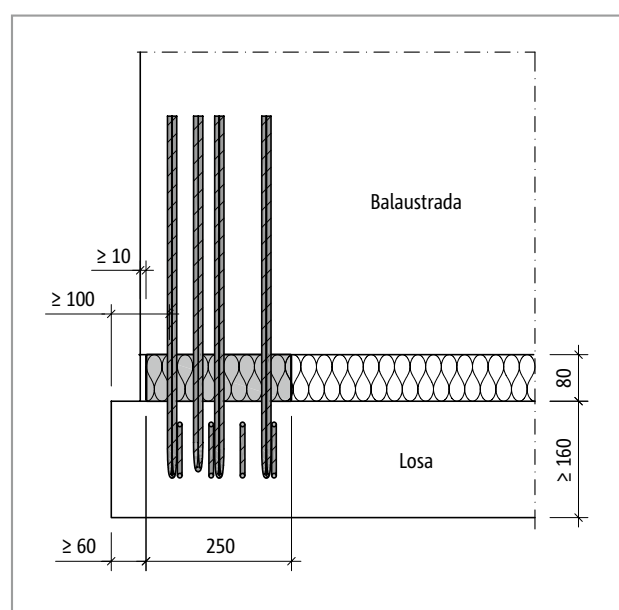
Schöck Isokorb® T tipo A: Vista de las distancias al borde
